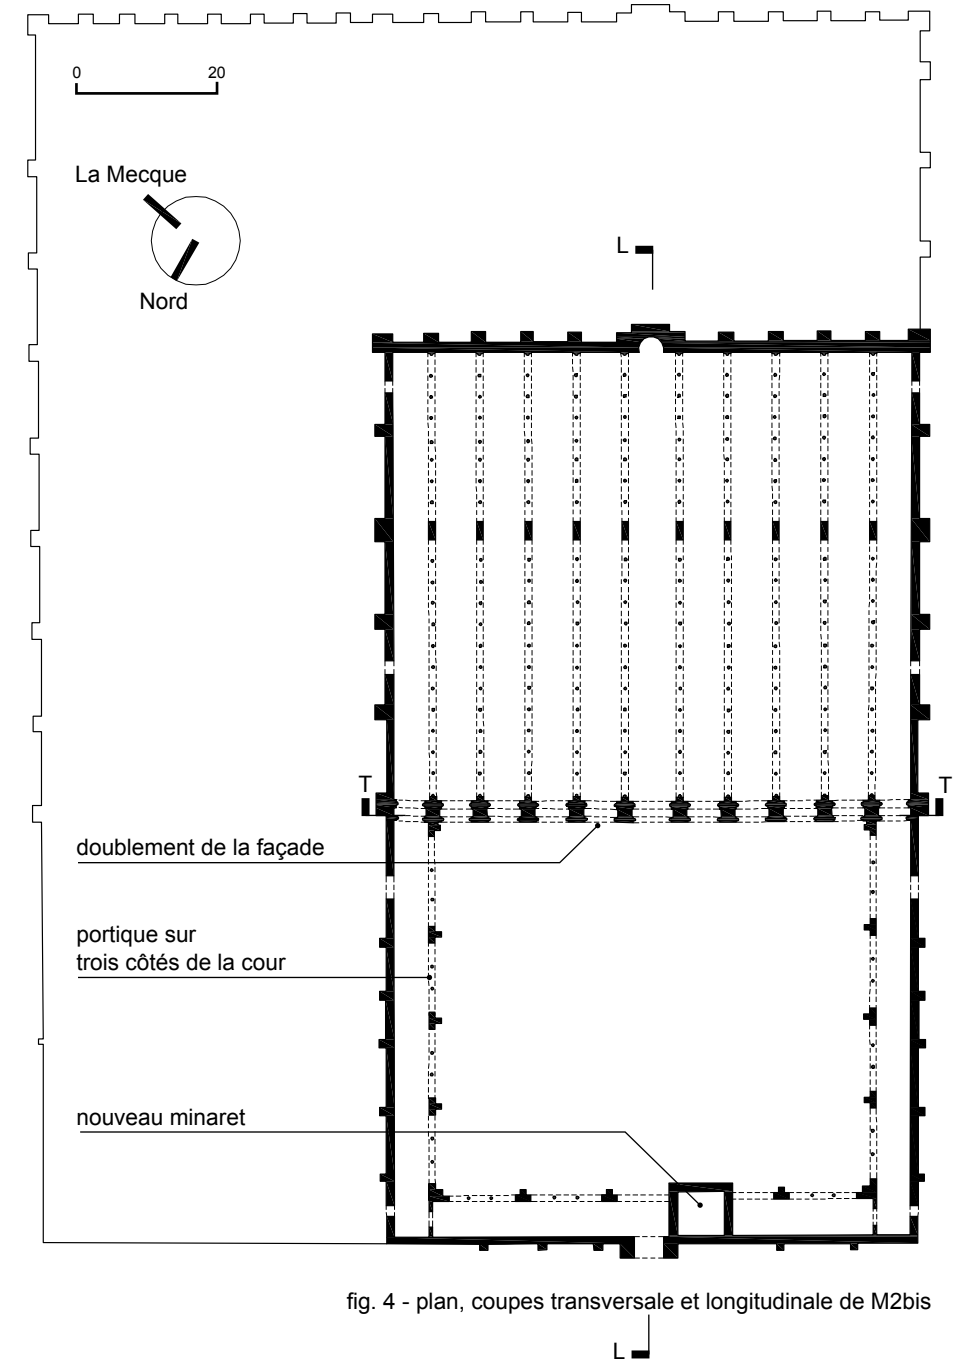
plan, coupes transversale et longitudinale de M2bis
